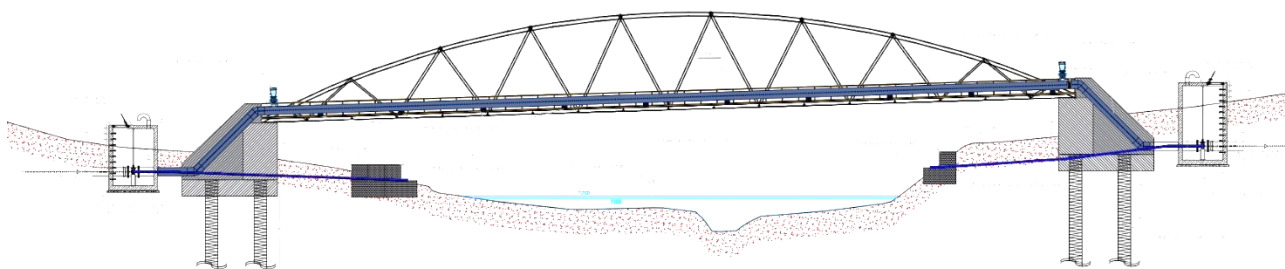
Profilo dell'attraversamento aereo del torrente Cavarretto
